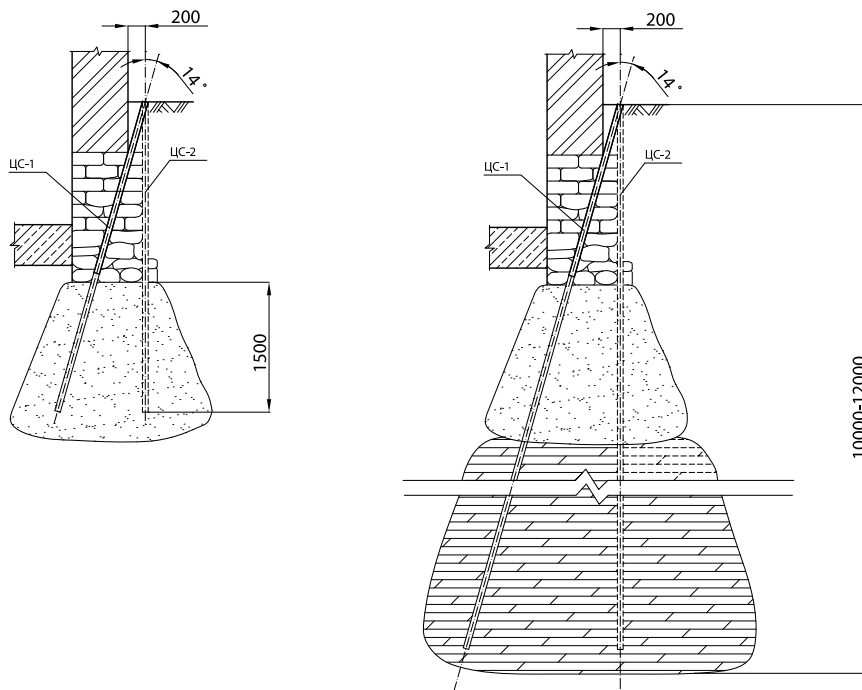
Инъециционные работы: а — усиление фундаментов и оснований под ними на первом этапе; б — компенсационное инъецирование при развитии осадки
